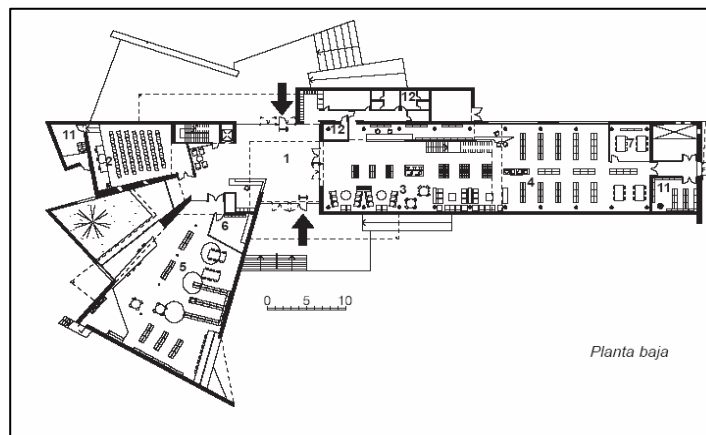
Planta baja, Biblioteca Viladecans^[29]
